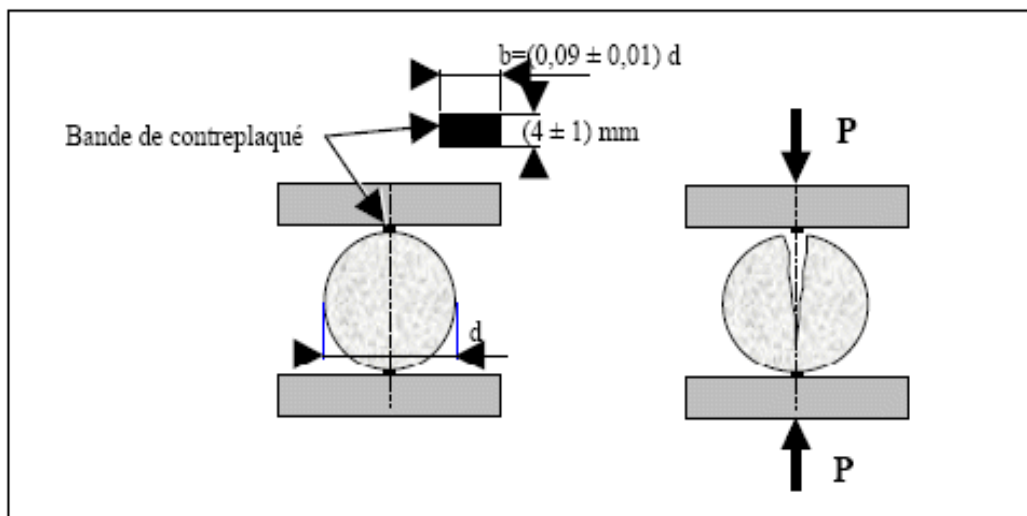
Dispositif pour l'essai de rupture par fendage.
